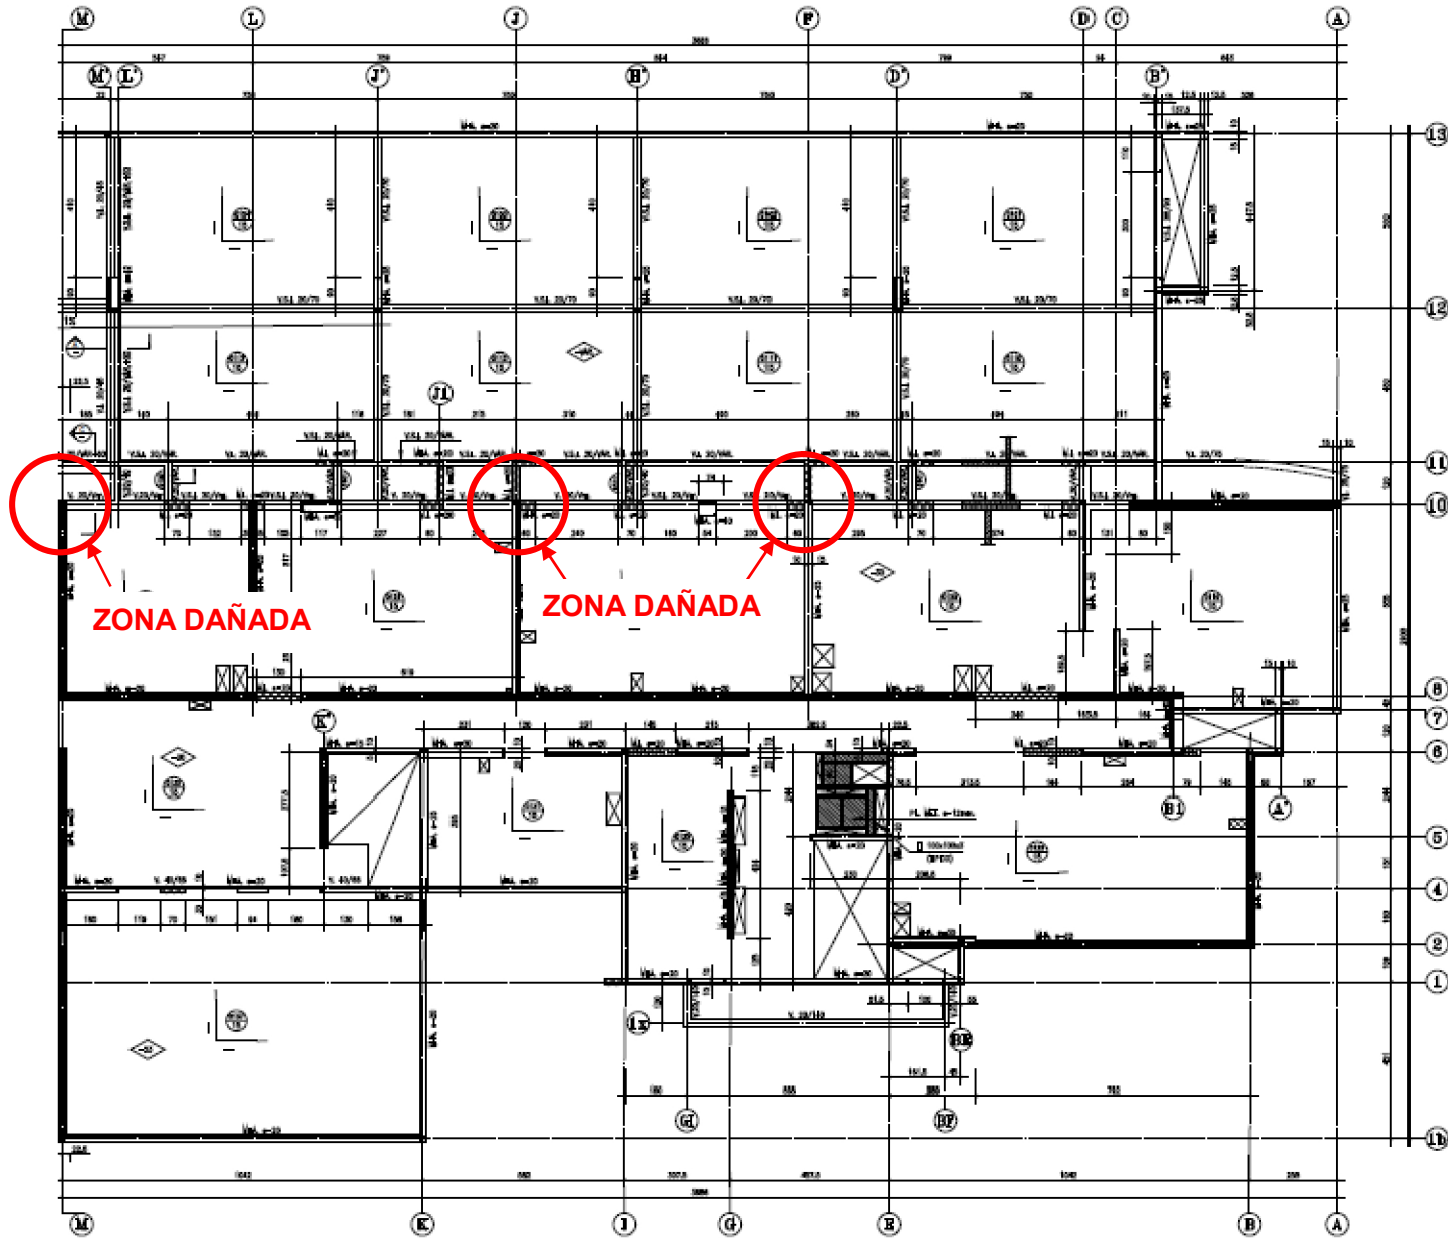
Zona Dañada - Planta cielo primer subterráneo, Edificio B.
